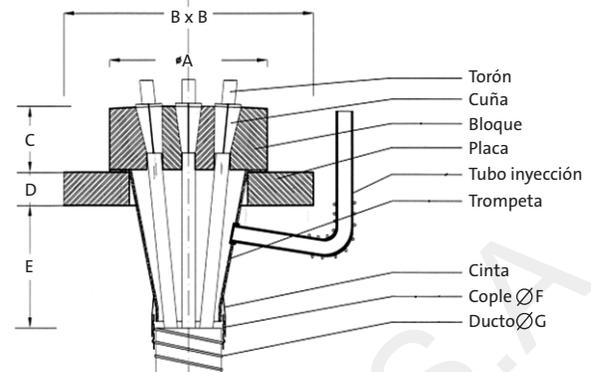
Dimensiones de los accesorios para el sistema K
